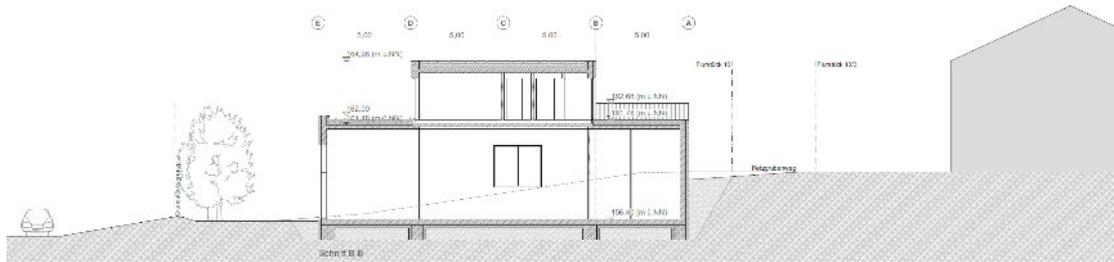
Gebäudeschnitt (Schaack + Schank Architekten, Stand: 25.05.2023)
